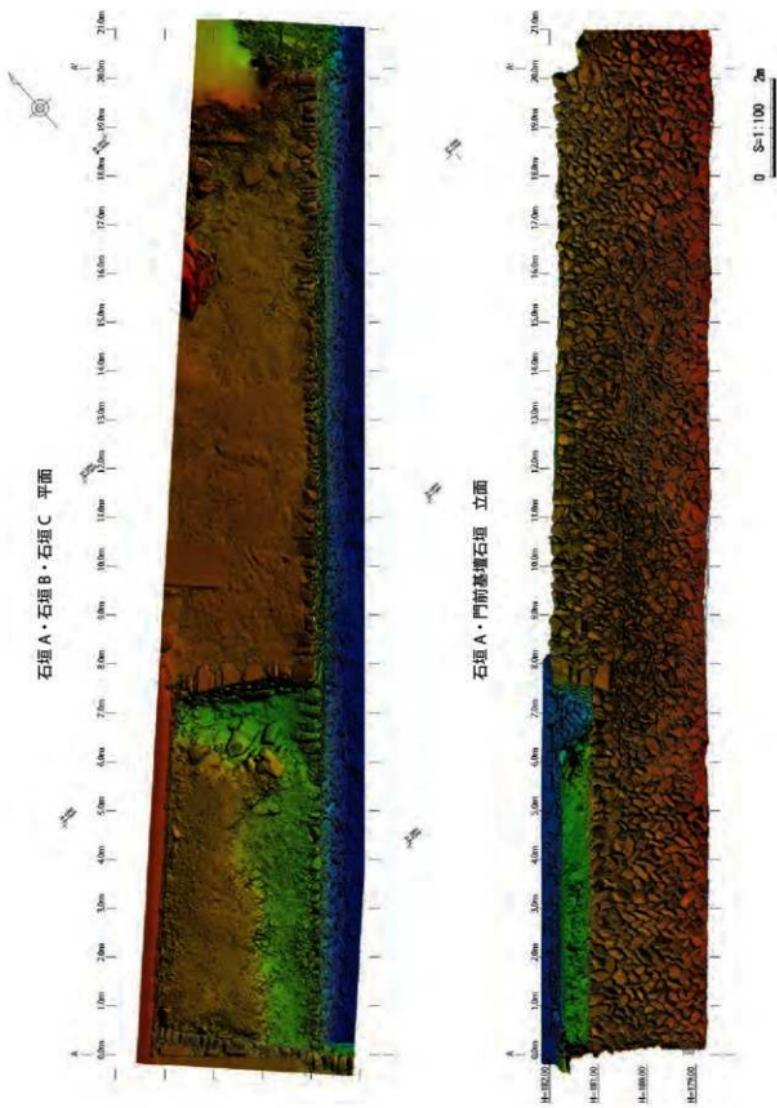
石垣 A・石垣 B・石垣 C 平面・立面 DEM 図
